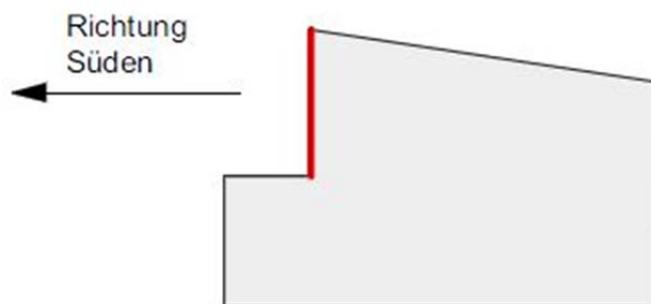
Prinzipskizze: Stellung der baulichen Anlagen in WA 2, Quelle: bhm
